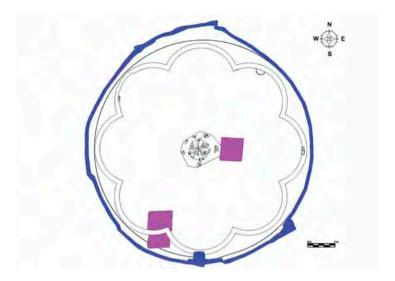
Plano general con la localización de los sondeos y la zanja perimetral.
